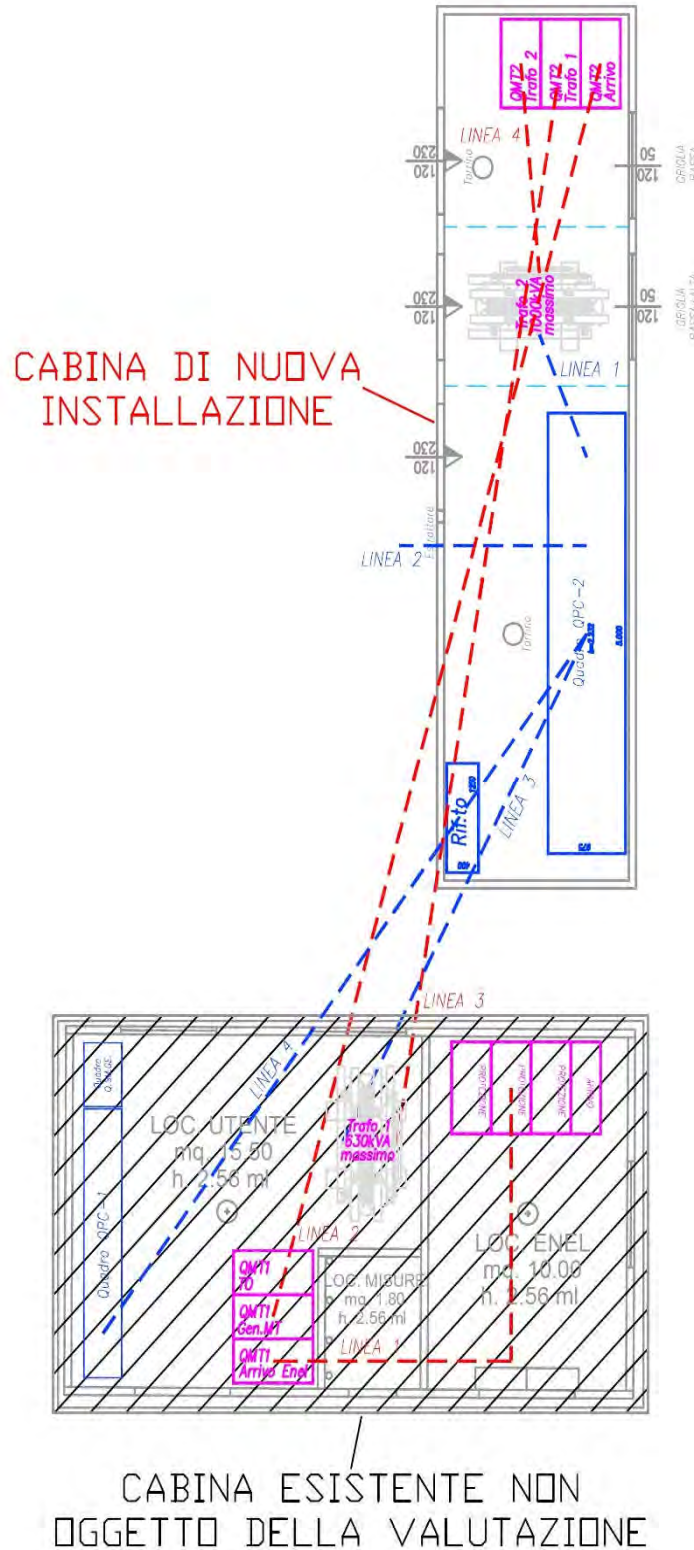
Pianta disposizione elementi in cabina (non in scala)
